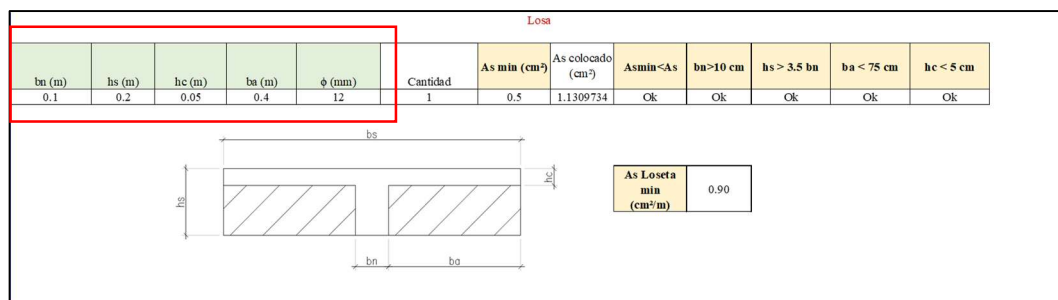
Chequeo de armadura del nervio en una losa nervada
